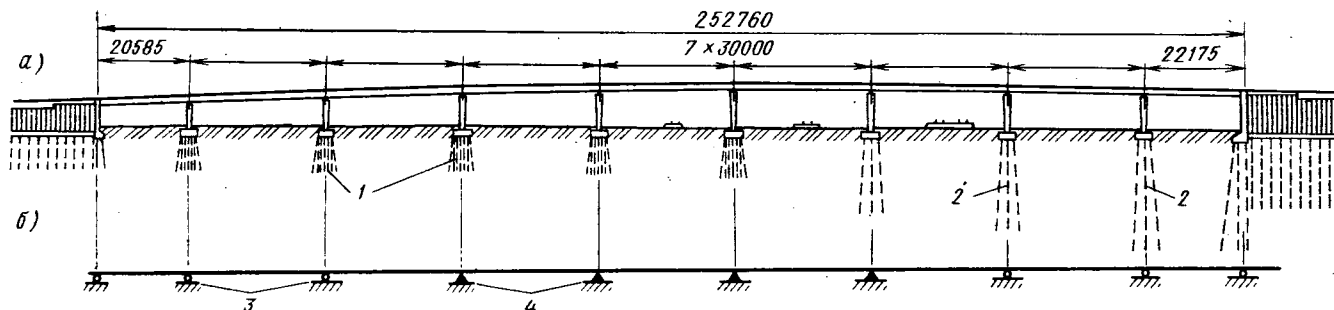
Фасад путепровода (а) и схема расположения опорных частей (б):
